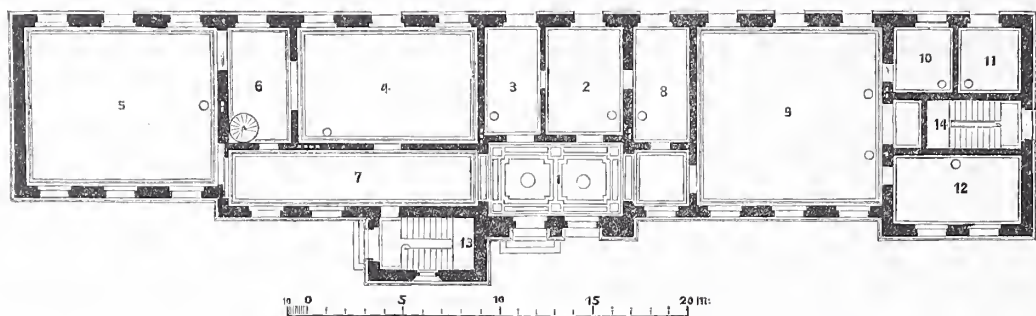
Grundriss vom Erdgeschoss.
